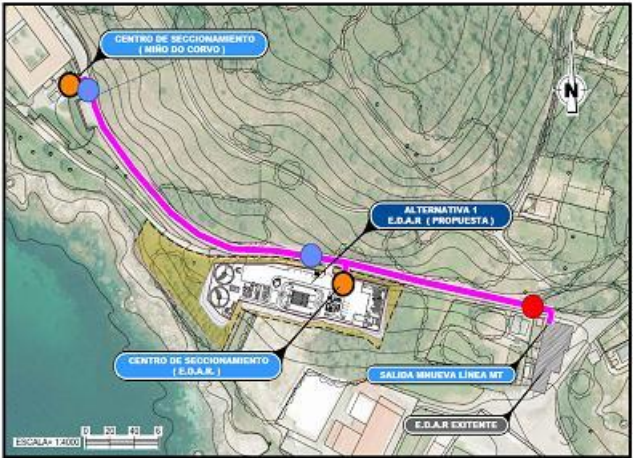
Presupuesto y equipamiento de "Compañía de Electrificación, S.L." y planta de Acometida MT. Alternativa 1
